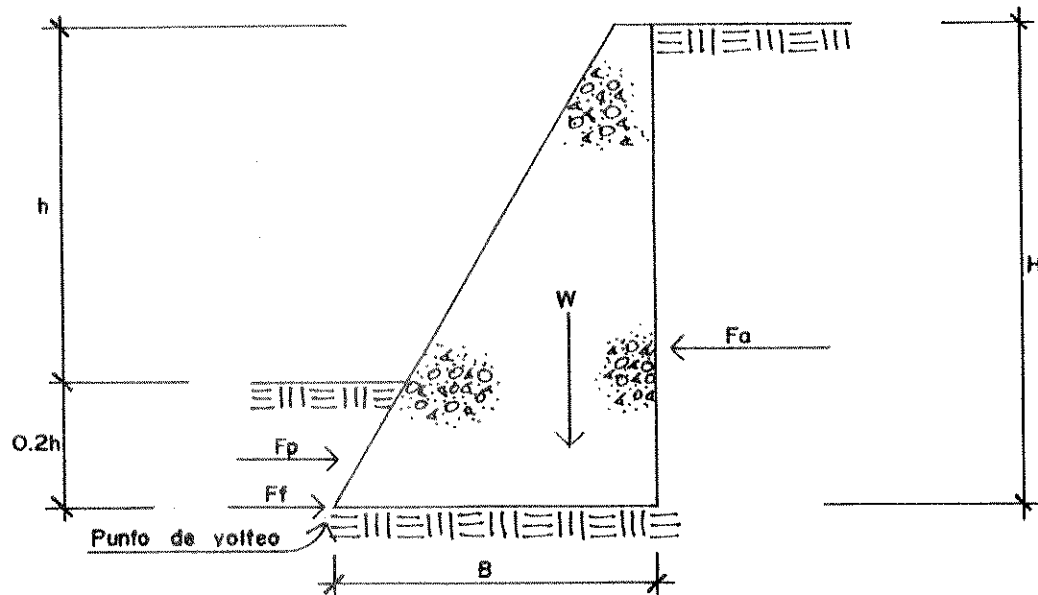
Modelo matemático de muro de gravedad de concreto
